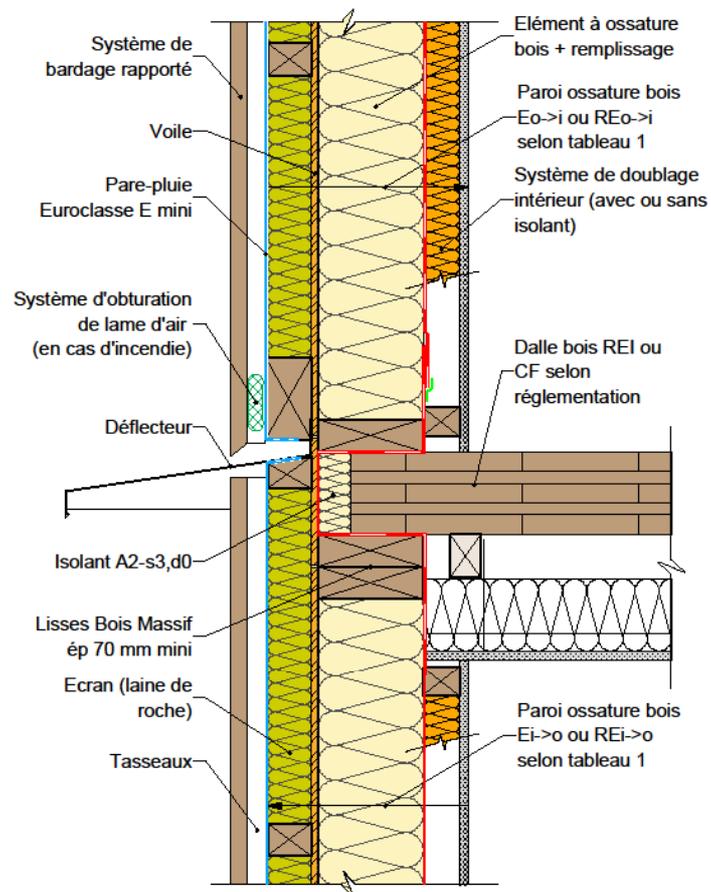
Façade/mur ossature bois & plancher en panneau bois massif.
